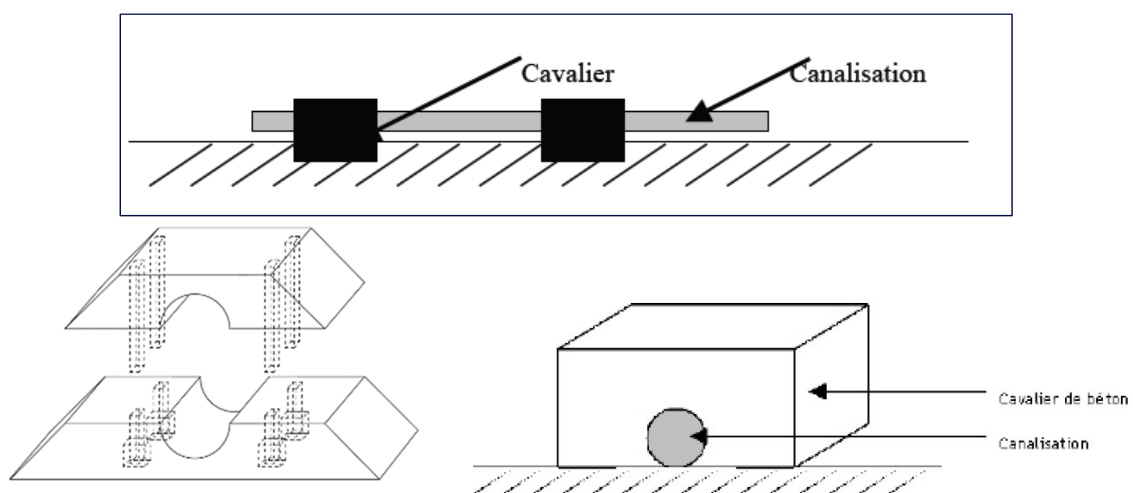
Représentation schématique d'une conduite lestée avec des cavaliers béton
